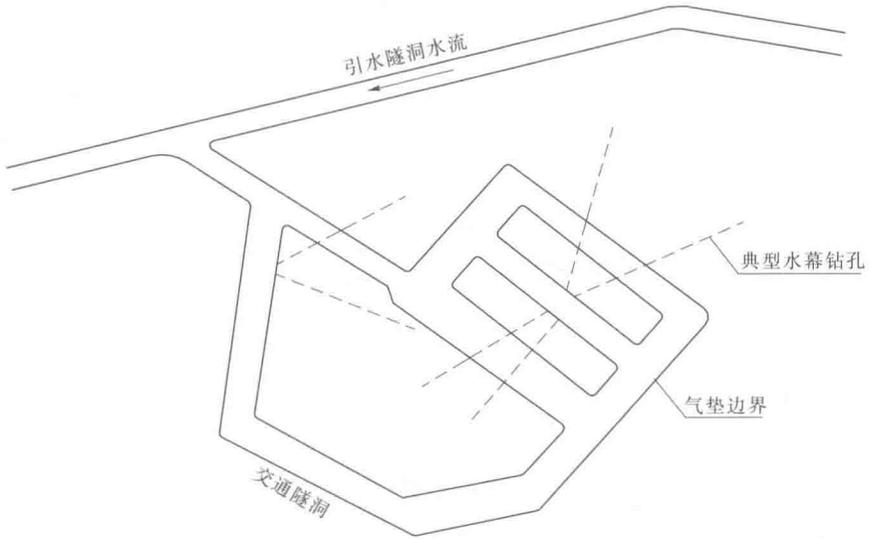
挪威 Kvilldal 电站气垫式调压室平面图
